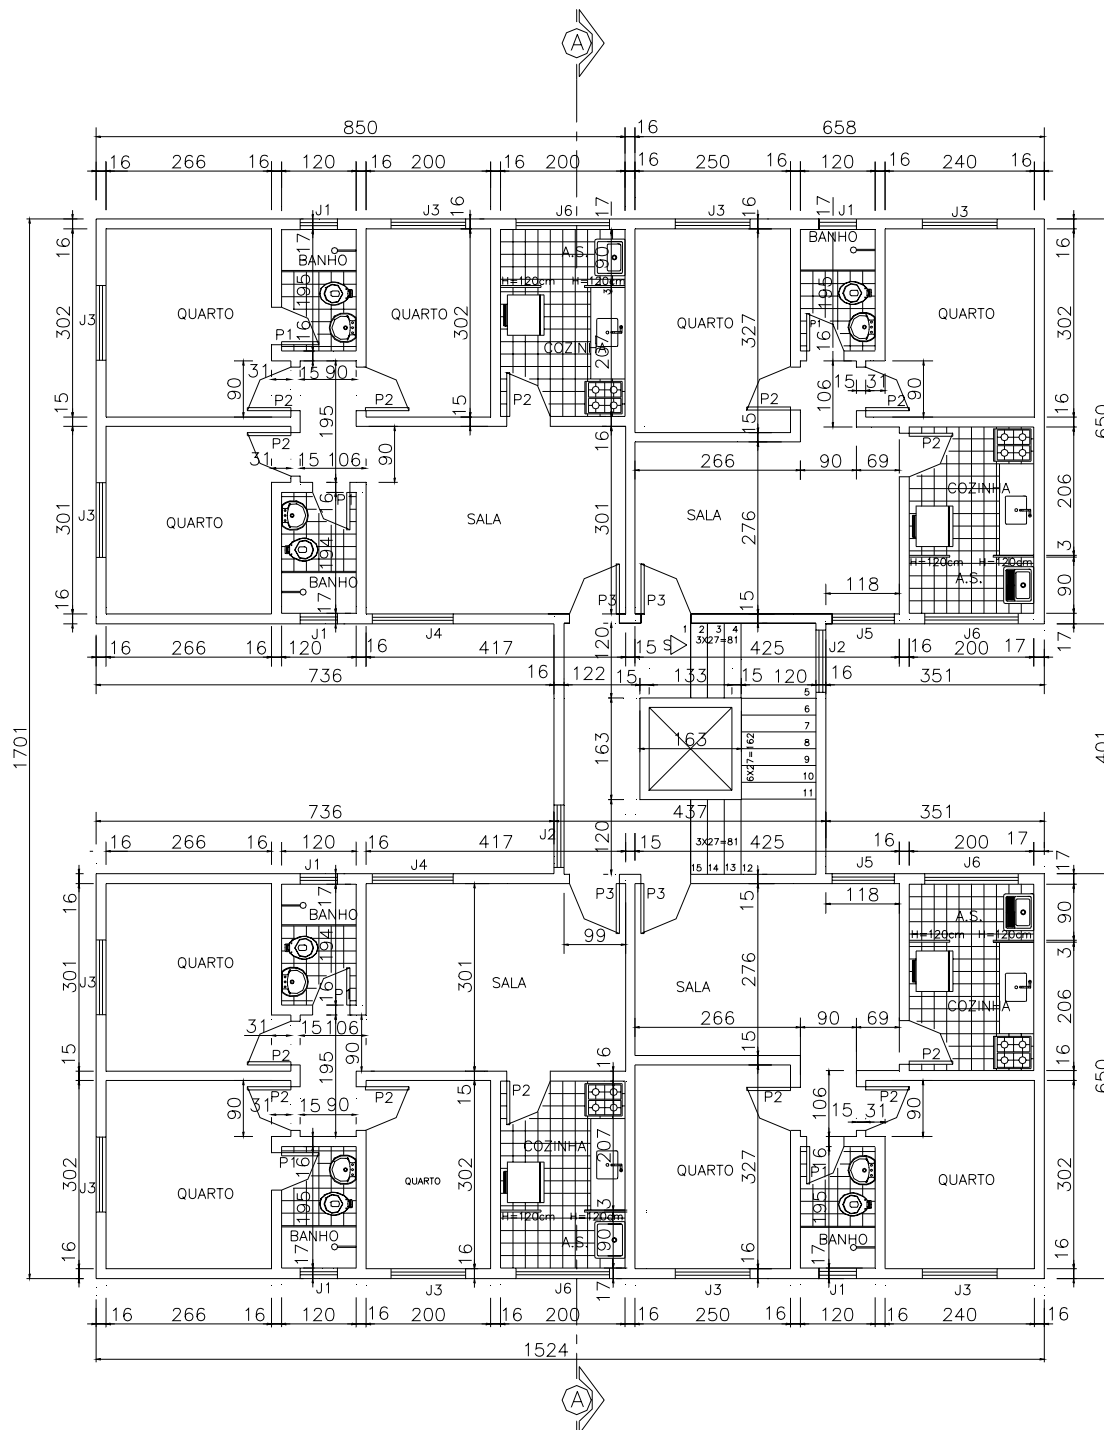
Prédio “A” – Planta com a arquitetura do Pavimento Tipo
